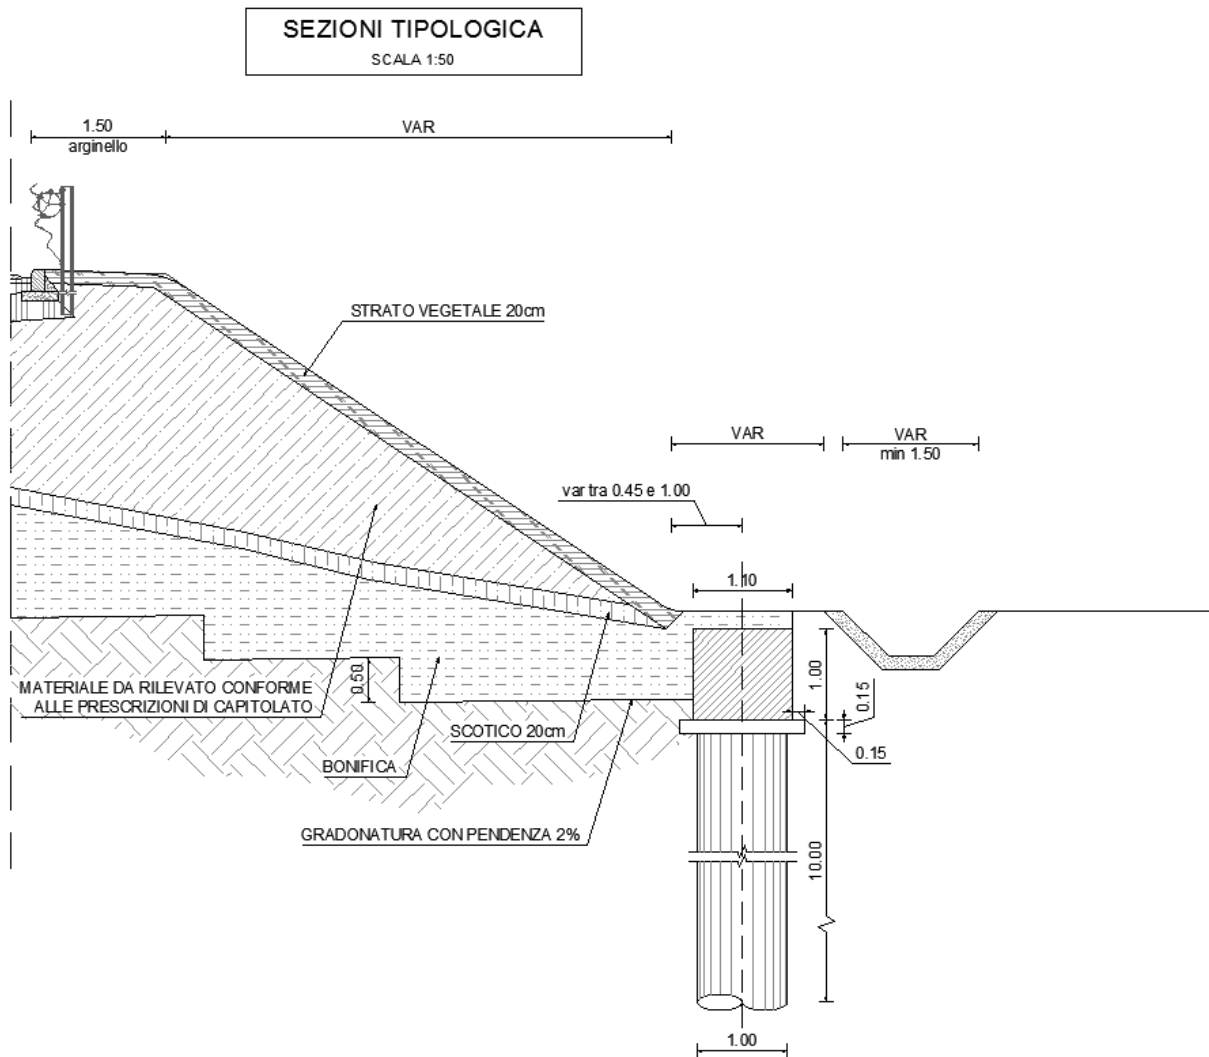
Opera di protezione del rilevato – sezione tipologica
